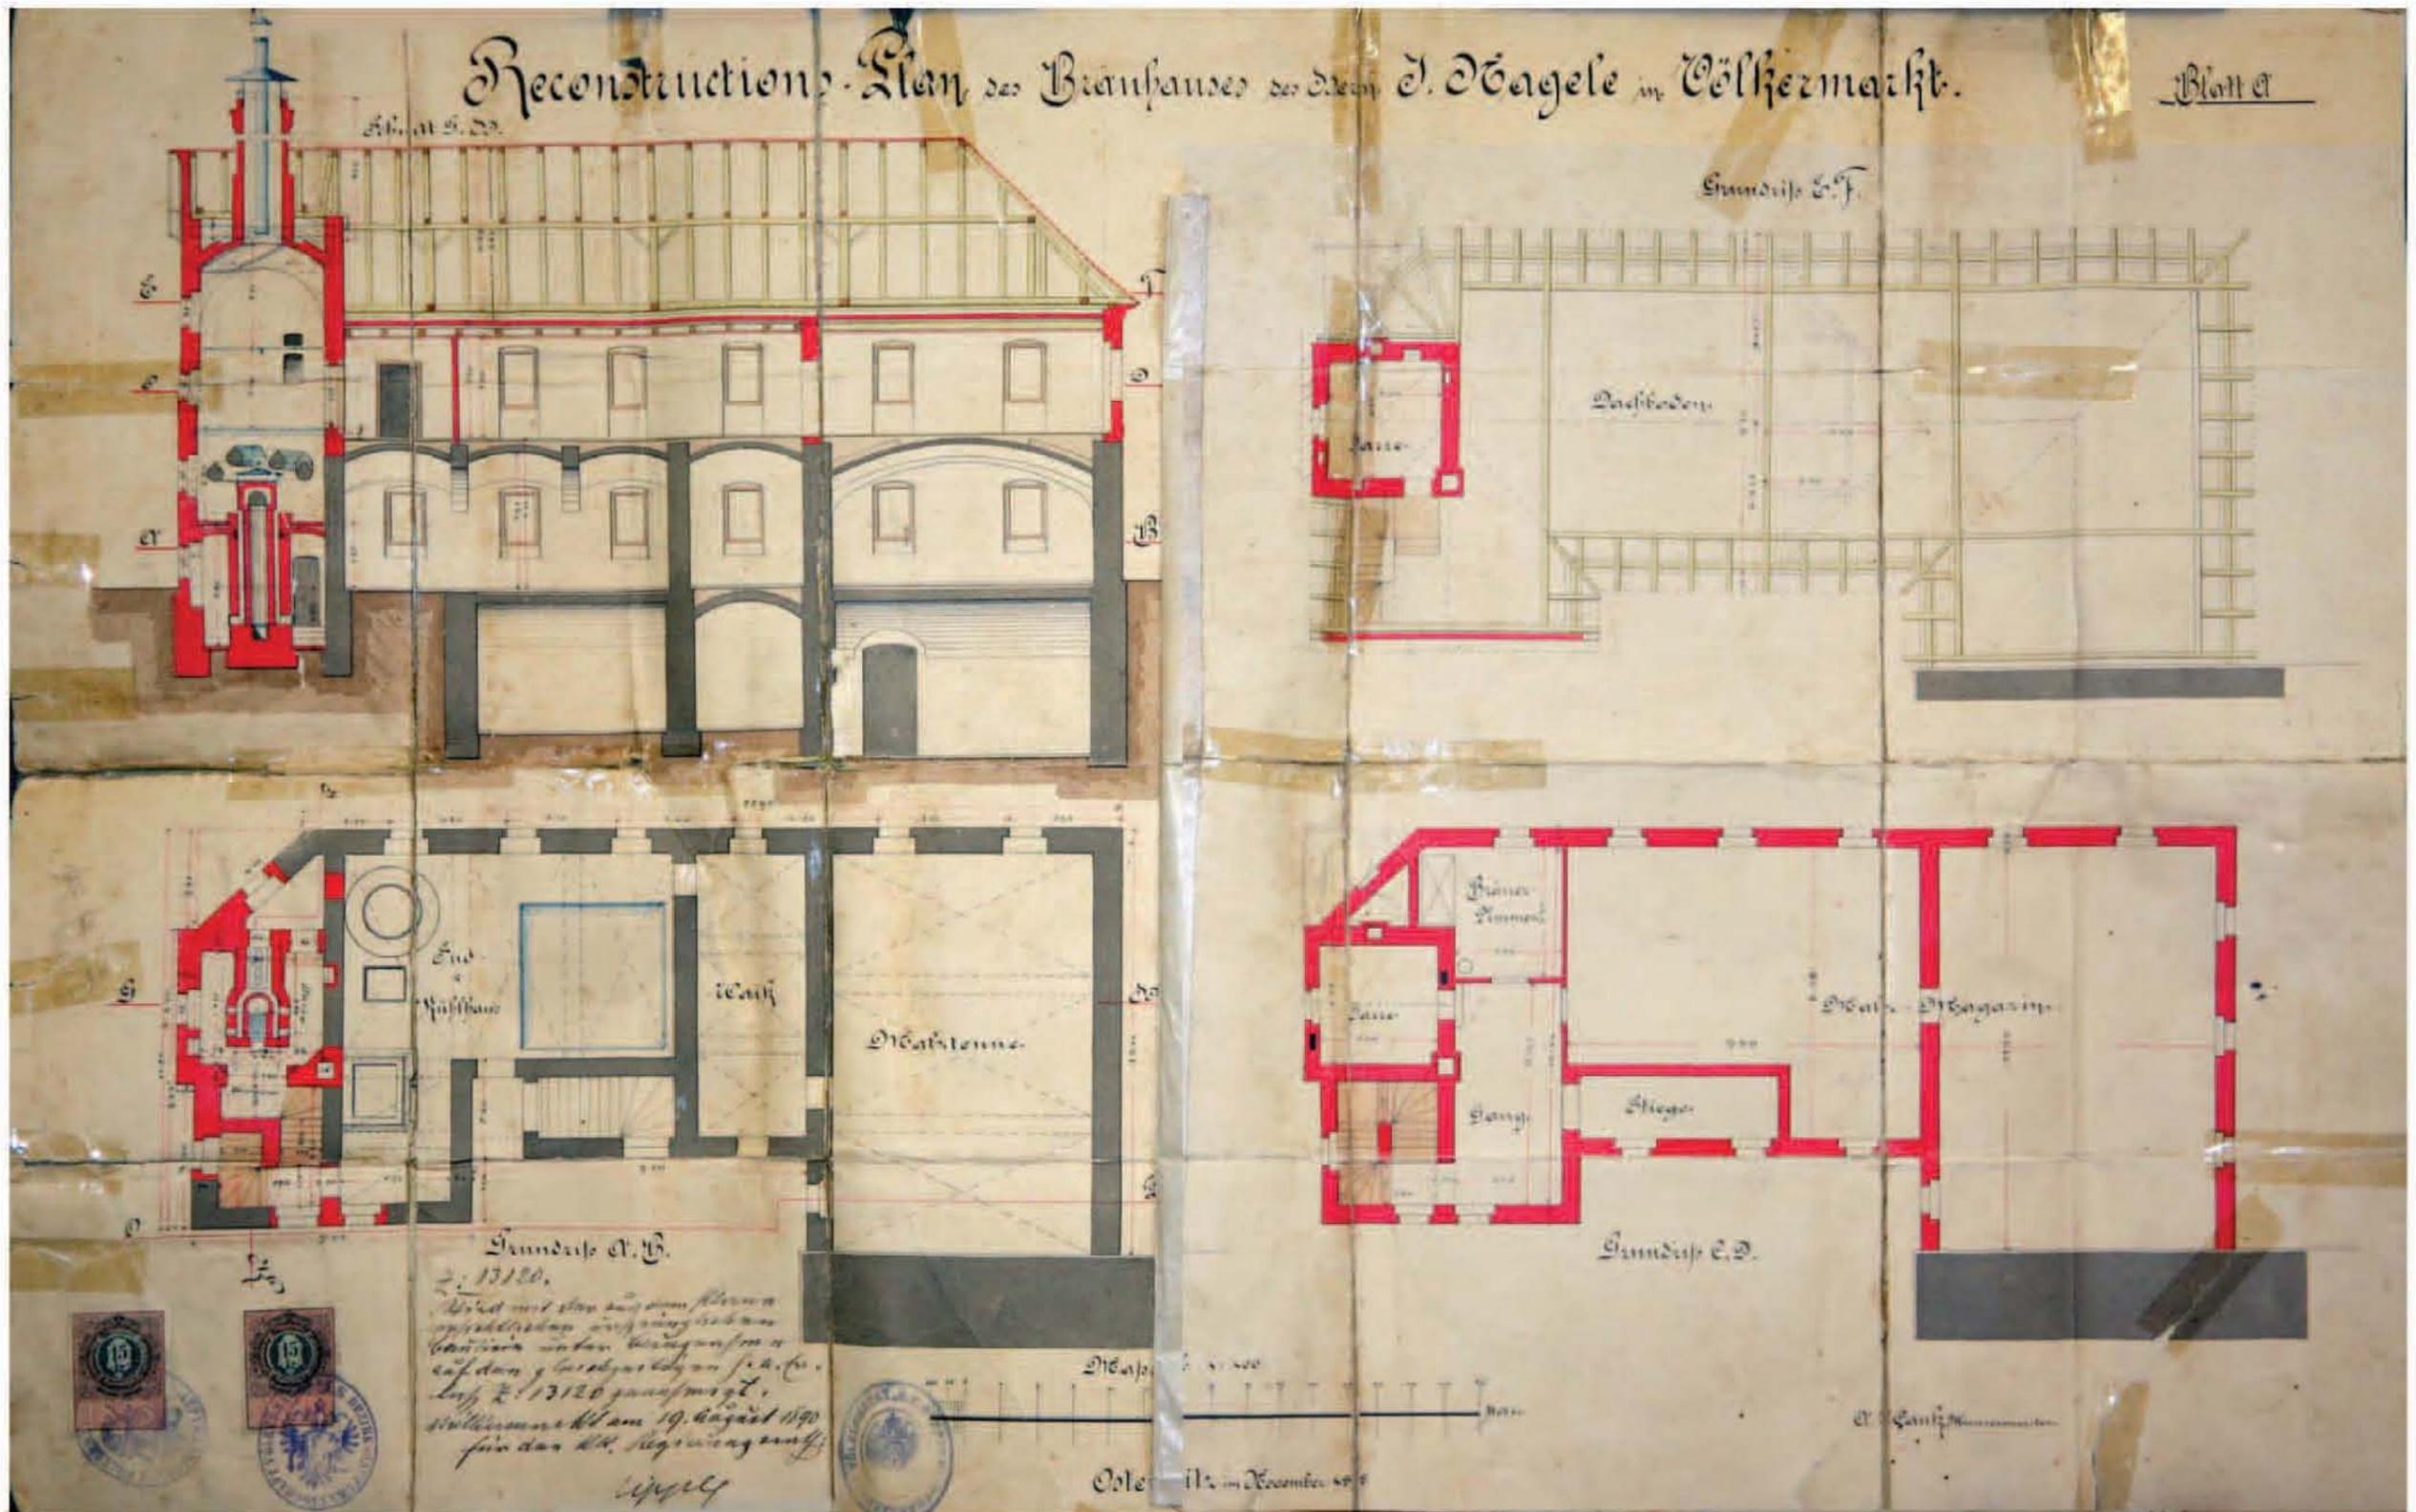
Ausbau im Brauereigebäude 1889 Schnitt und Grundrissebenen des Brauereigebäudes
